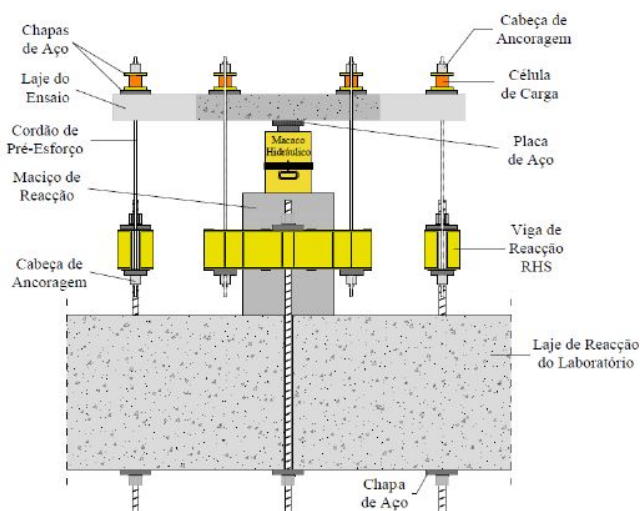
Sistema de ensaio laje hexagonal (adaptado de [8])
